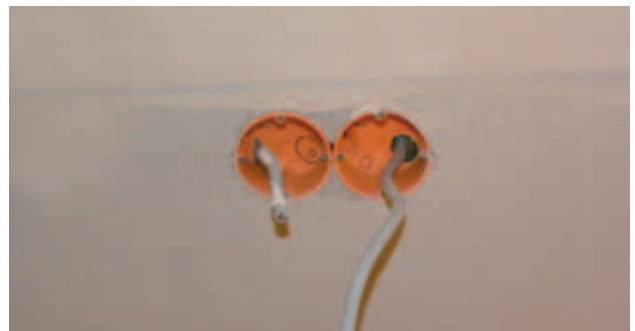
Colocación y fijación de la caja de enchufe (electricista)
